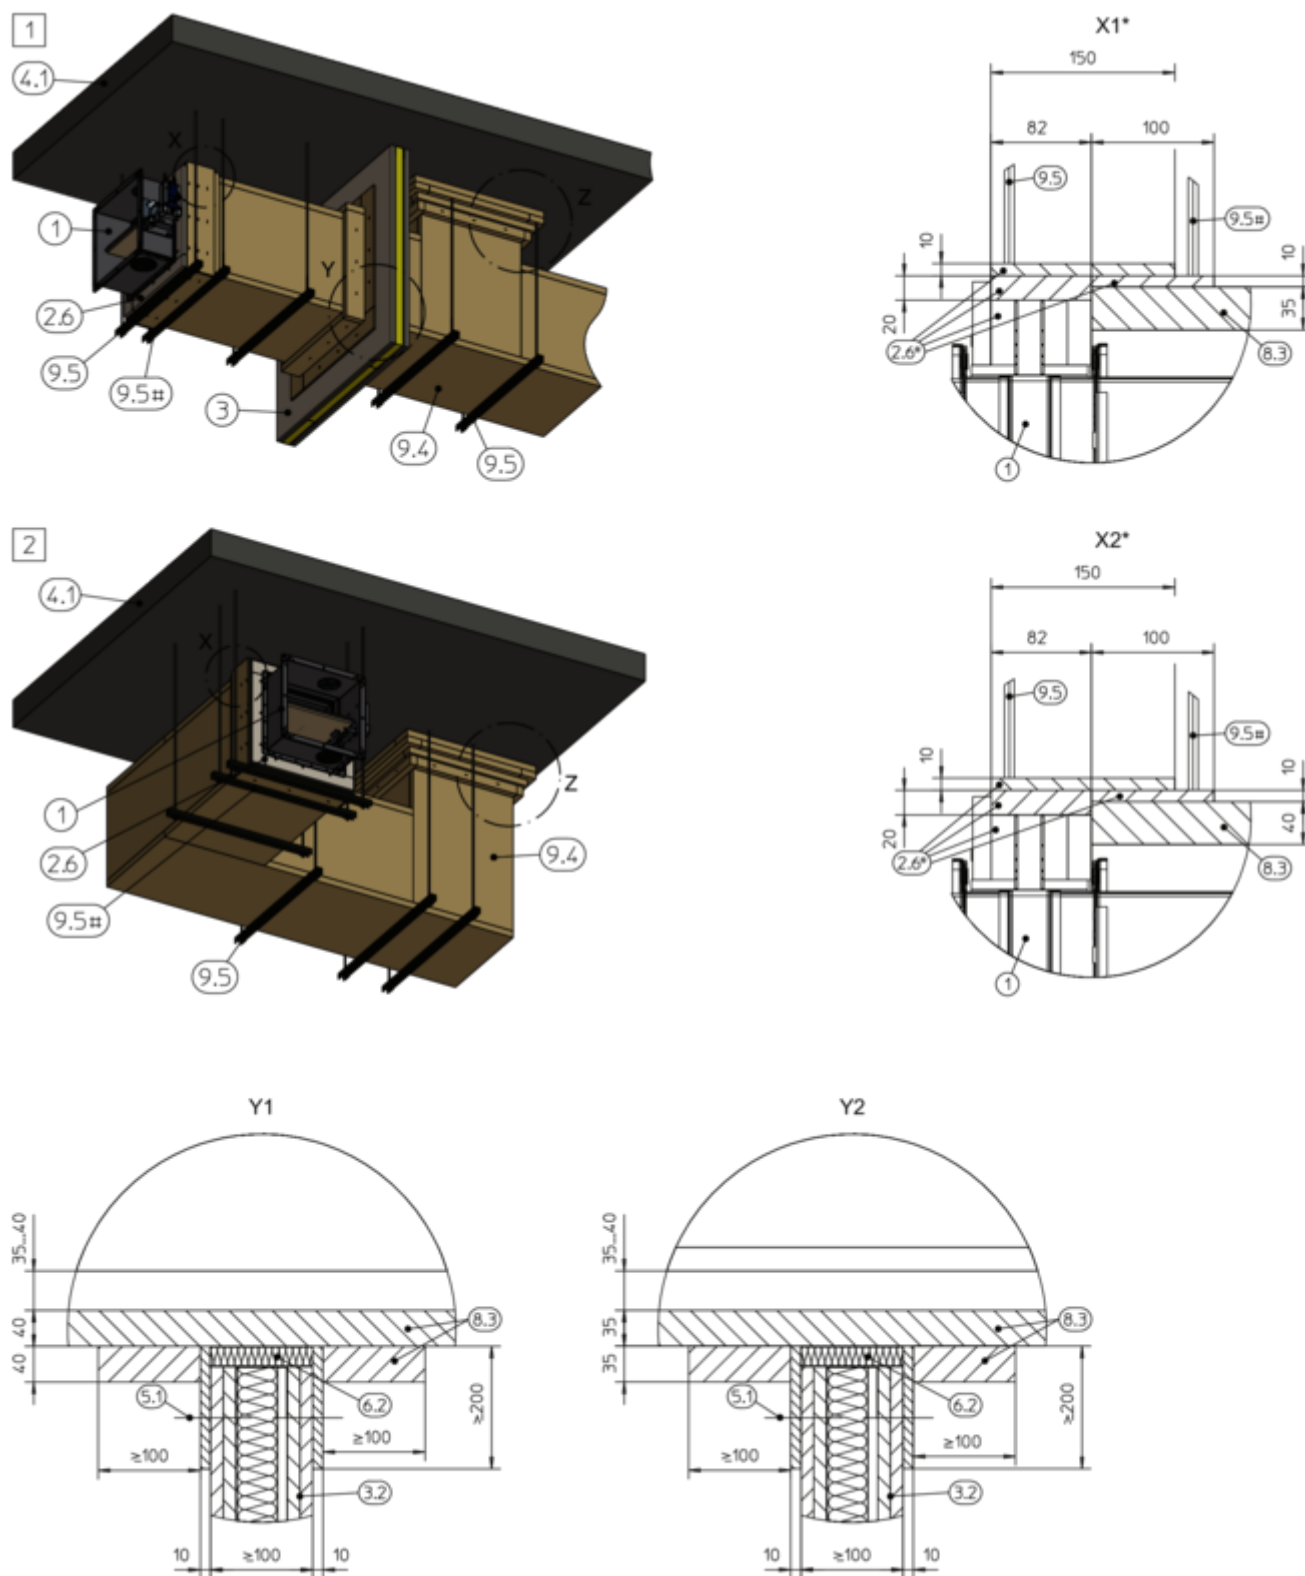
Torr installation utan murbruk ovan en massiv våningsavskiljning med installationskit WA
